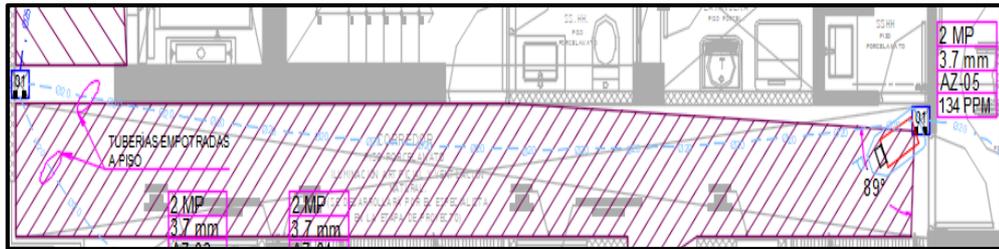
Ubicación de equipos en pasadizos de la azotea
